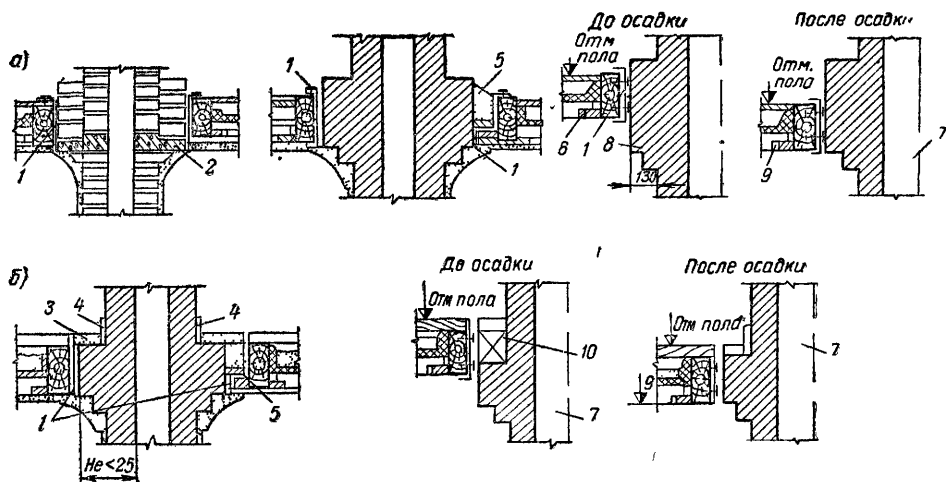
Разделки труб и дымоходов в деревянных перекрытиях
